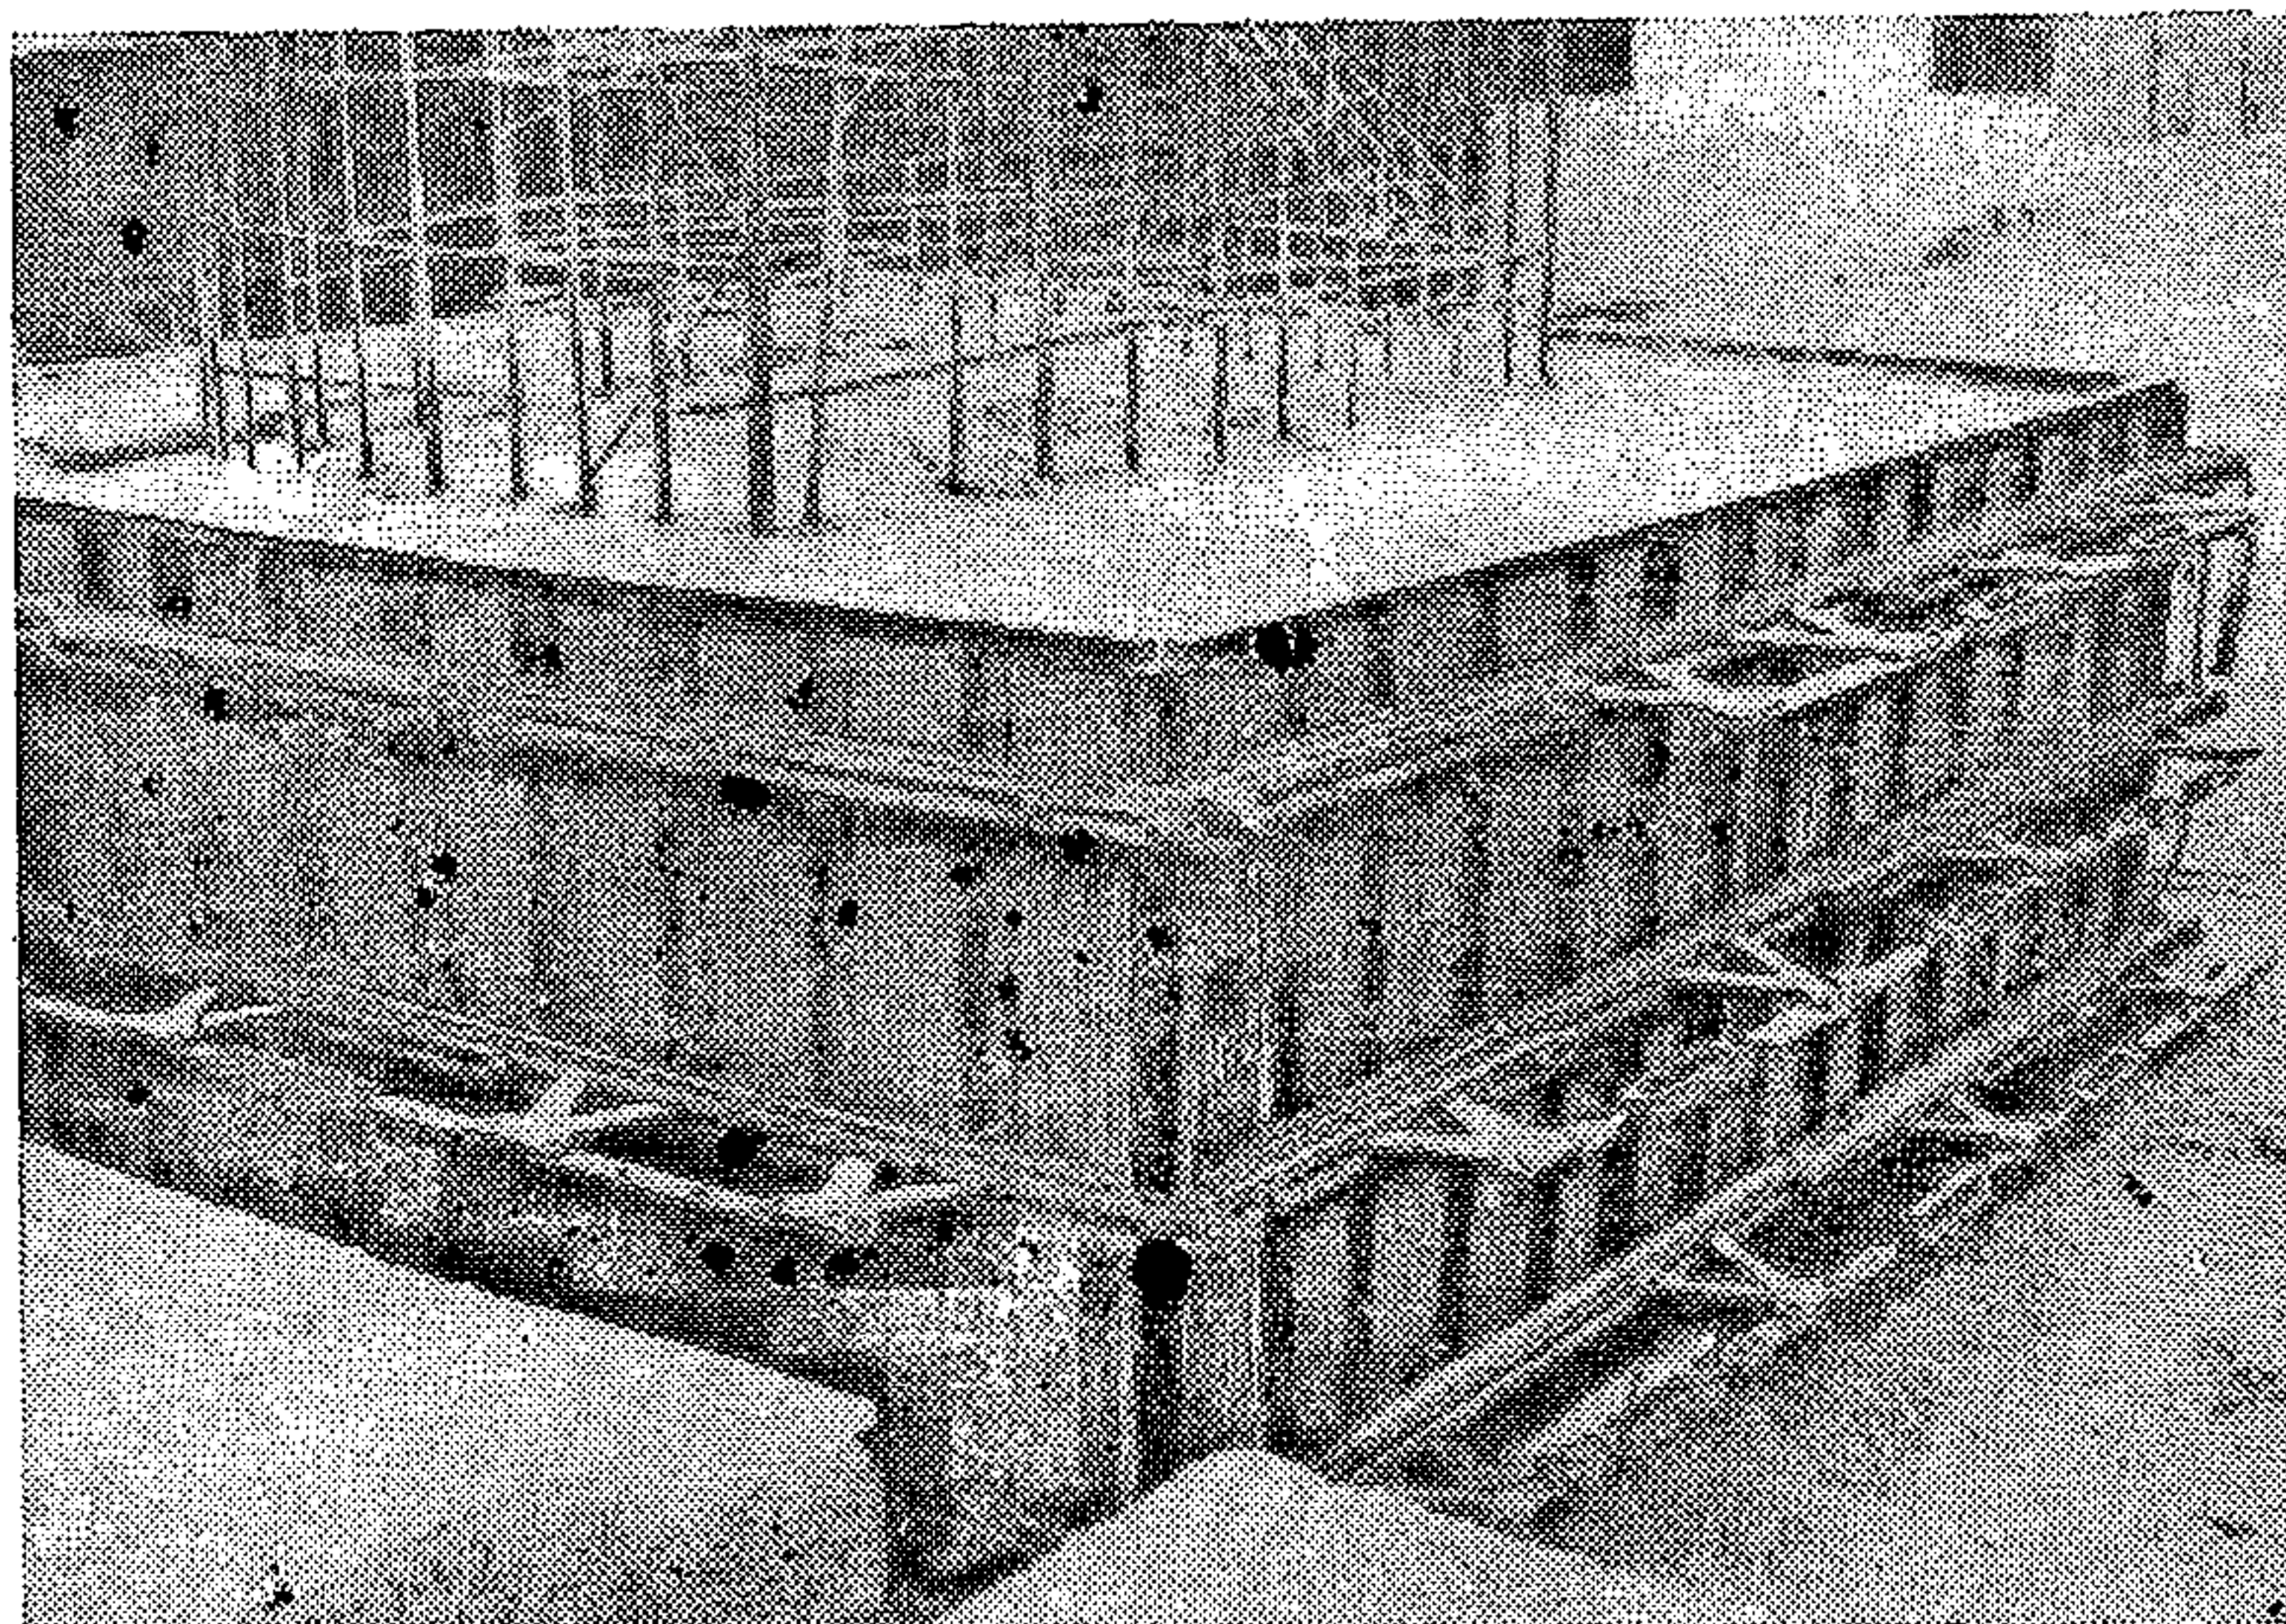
Блочная опалубка фундамента с угловыми блокирующими элементами и составными фермами
